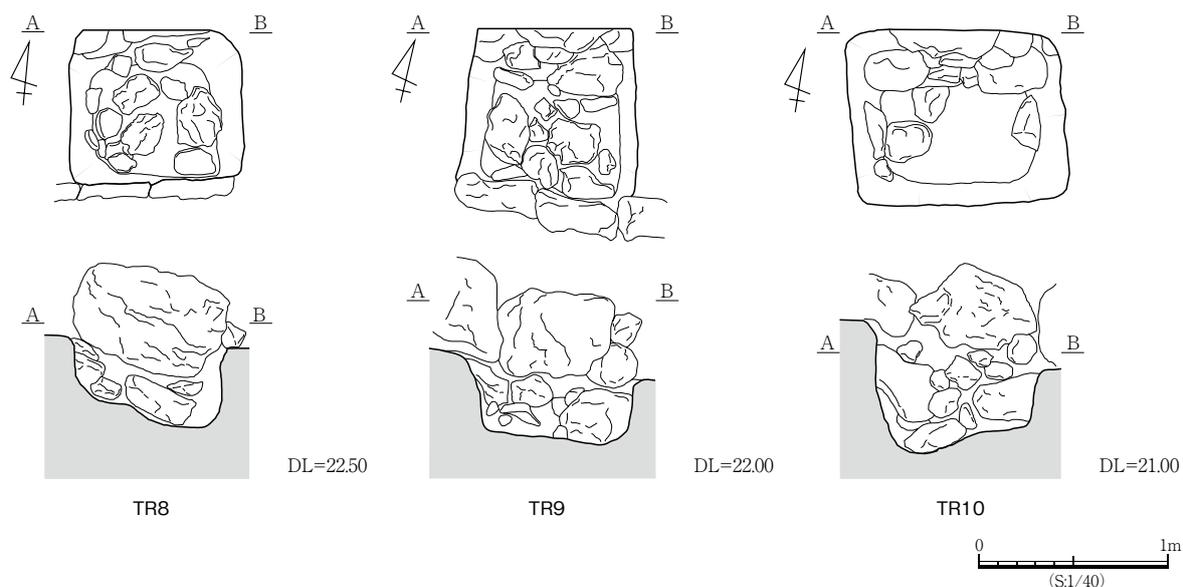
平成19年度B1面根石確認トレンチ平面図・断面図
